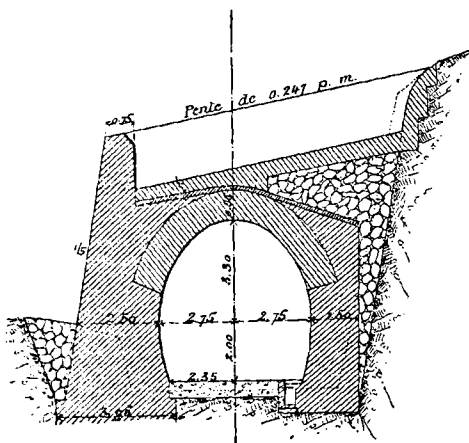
Coupe de la tranchée voûtée à 6 mètres du portail d'entrée du tunnel de San Rocco.
